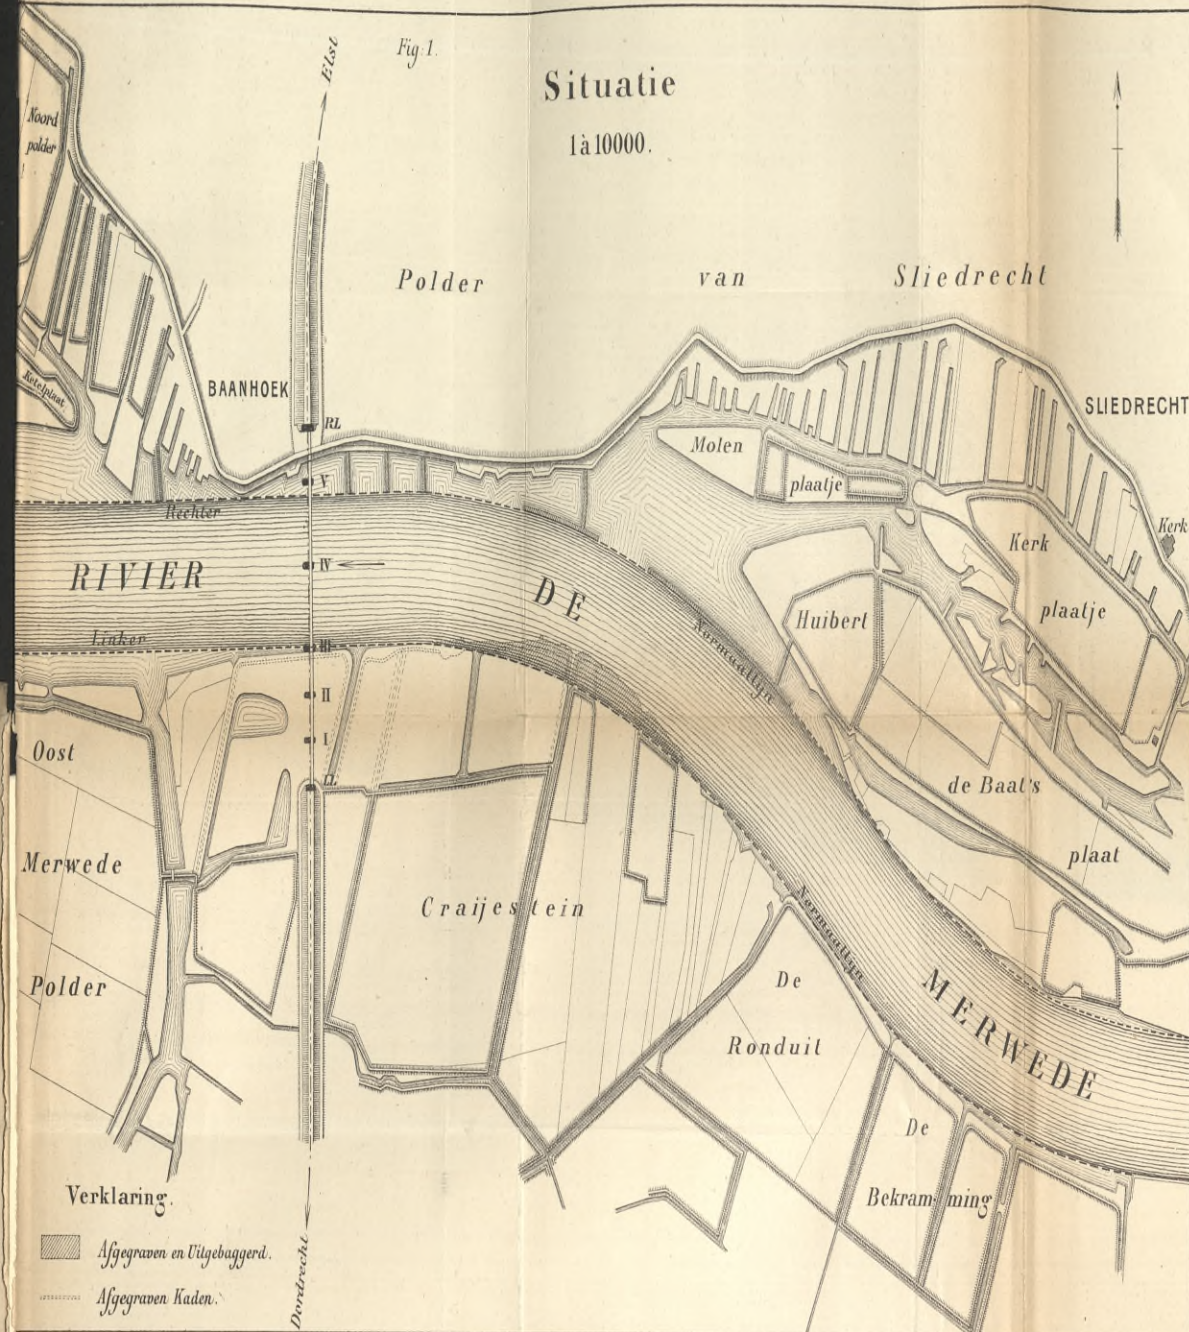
BRUG OVER DE BENEDEN MERWEDE BIJ BAANHOEK
